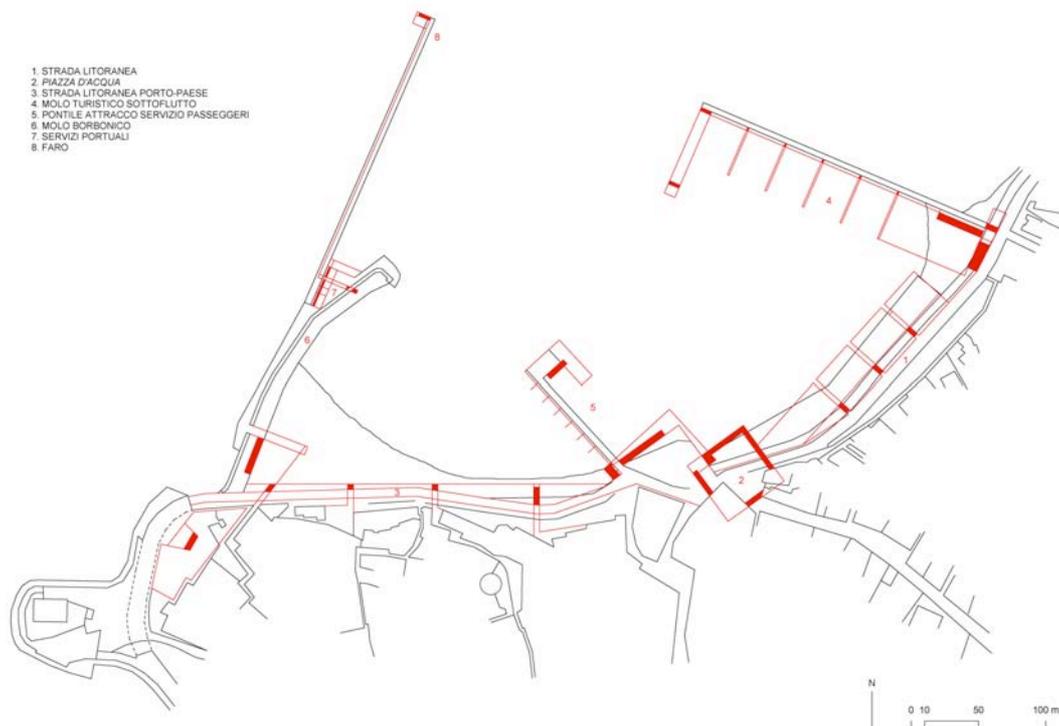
Porto di Forio, localizzazione e pianta del piano terreno della *piazza a mare* (Progetto A. Monaco)
